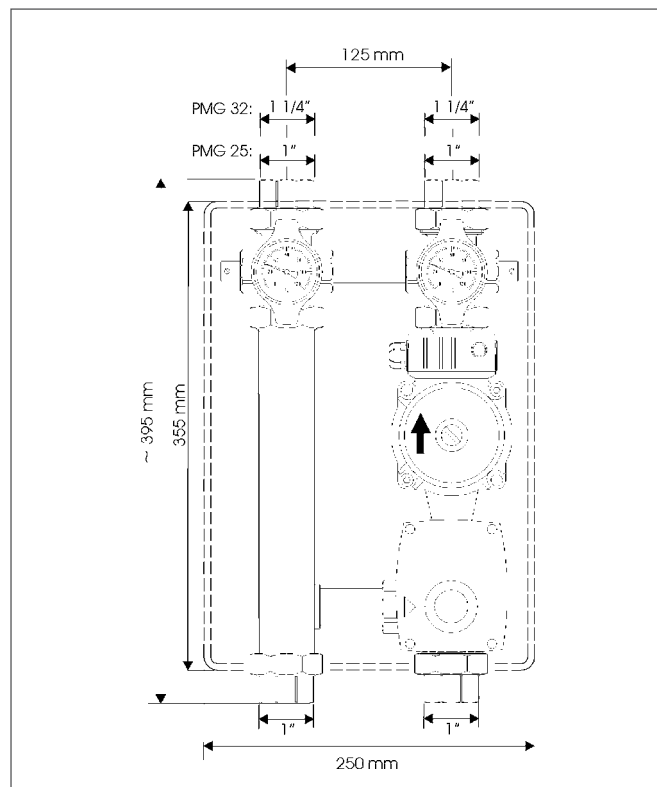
Dimensiuni grup de pompe-amestec REHAU PMG-25, PMG-32
